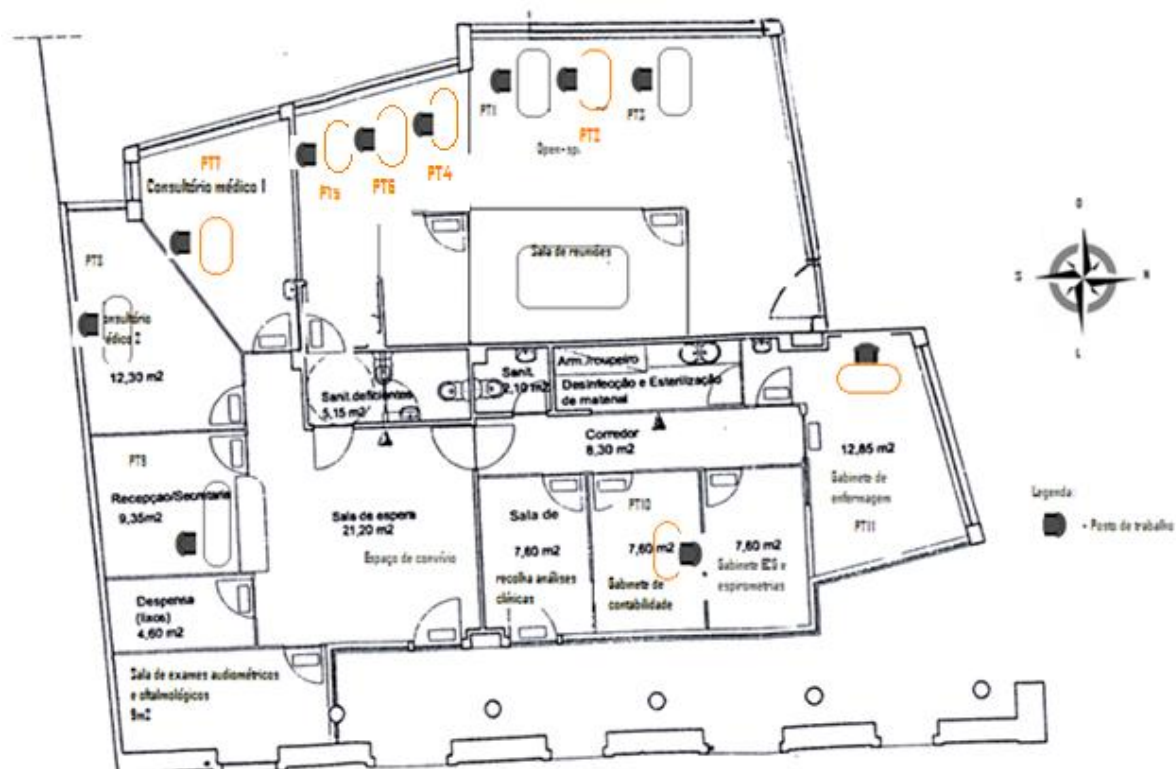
Planta com alteração da disposição dos postos de trabalho
